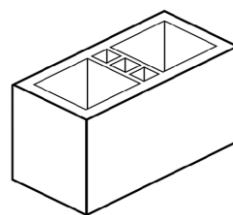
Bloco cerâmico estrutural de paredes vazadas
